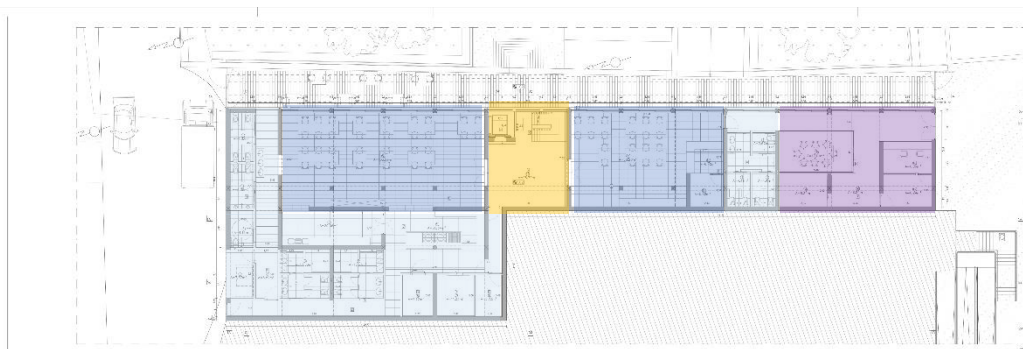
Esquema de planta do espaço de restauração e hotelaria - piso 0.
